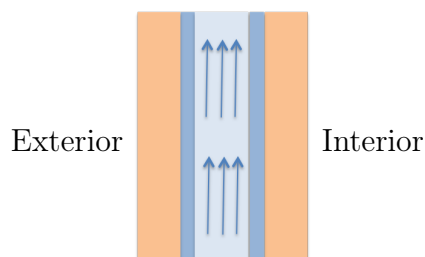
Esquema de fachada compuesta por: Elemento exterior masivo con aislante hacia la cámara, elemento interior masivo con aislante hacia la cámara.
